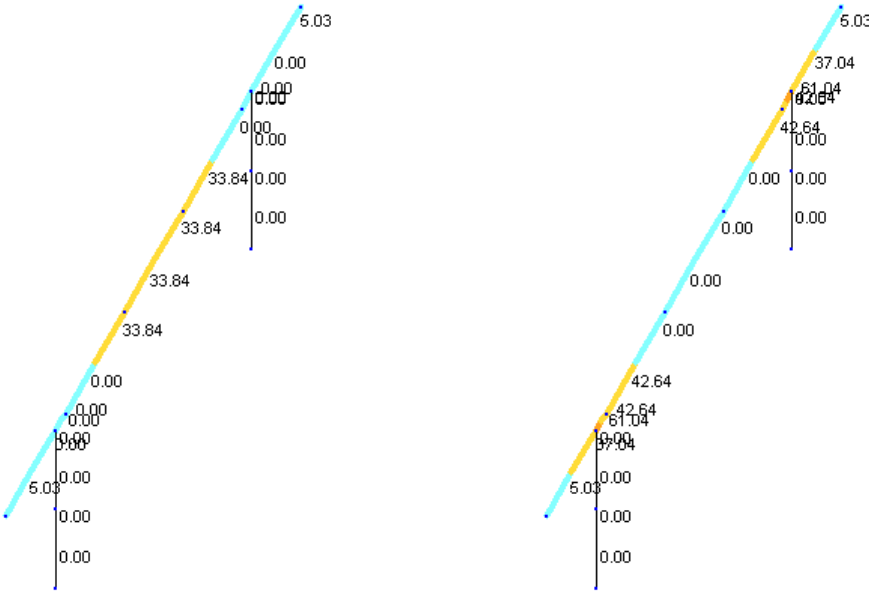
Сумарна площа верхнього і нижнього пояса арматури ригеля опори № 6
